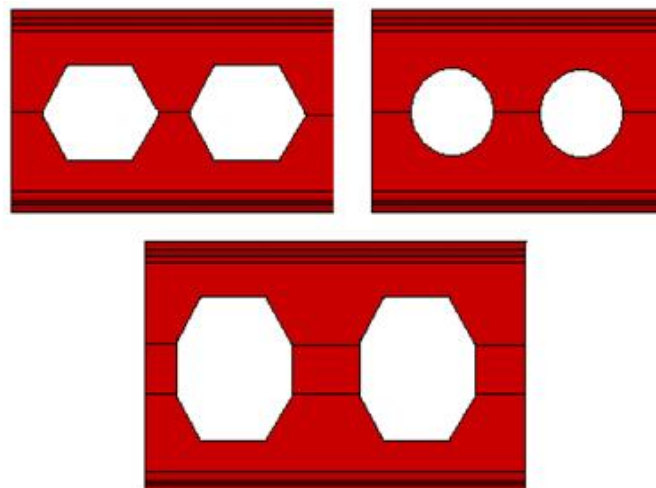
Tipos de vigas alveoladas Boyd o alveolar.
